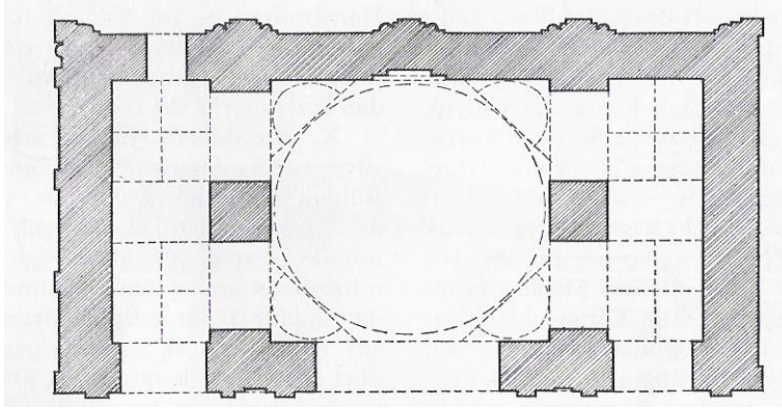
Hazar Degaron Camii ve plan (URL 12, Aslanapa, 1993)
